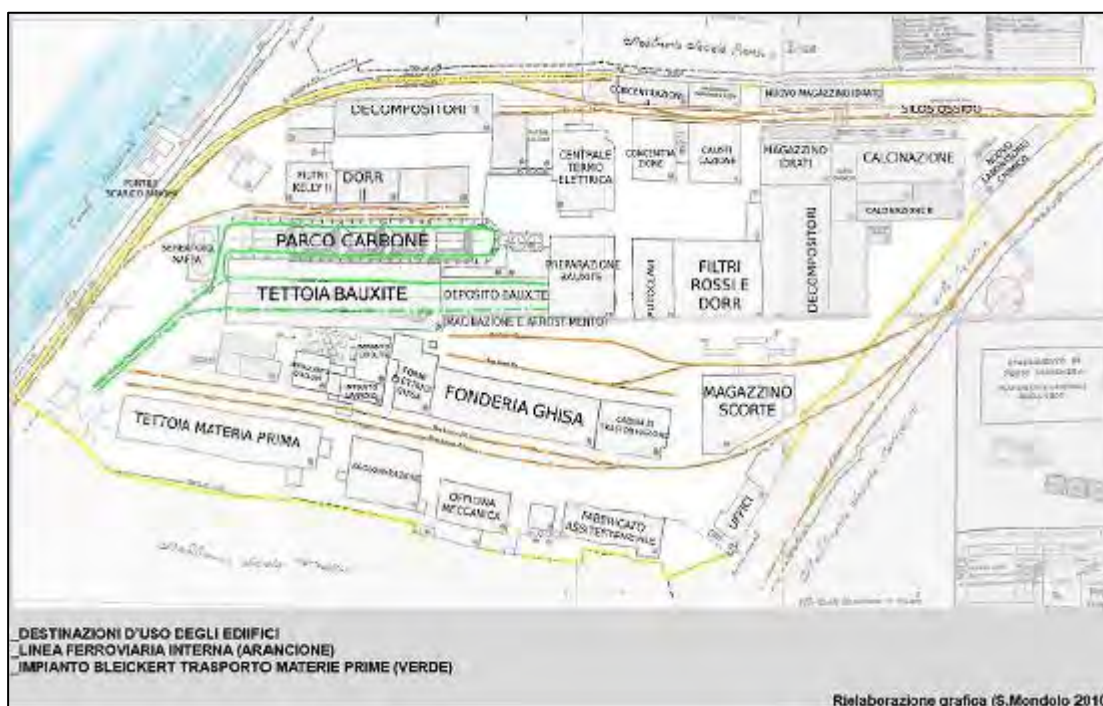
Planimetria dello stabilimento Ina nel 1942 con identificazione dei reparti principali (fonte: elaborazione di Silvia Mondolo su planimetria del 1942 nell'ambito del lavoro svolto per master MPI 2010)
